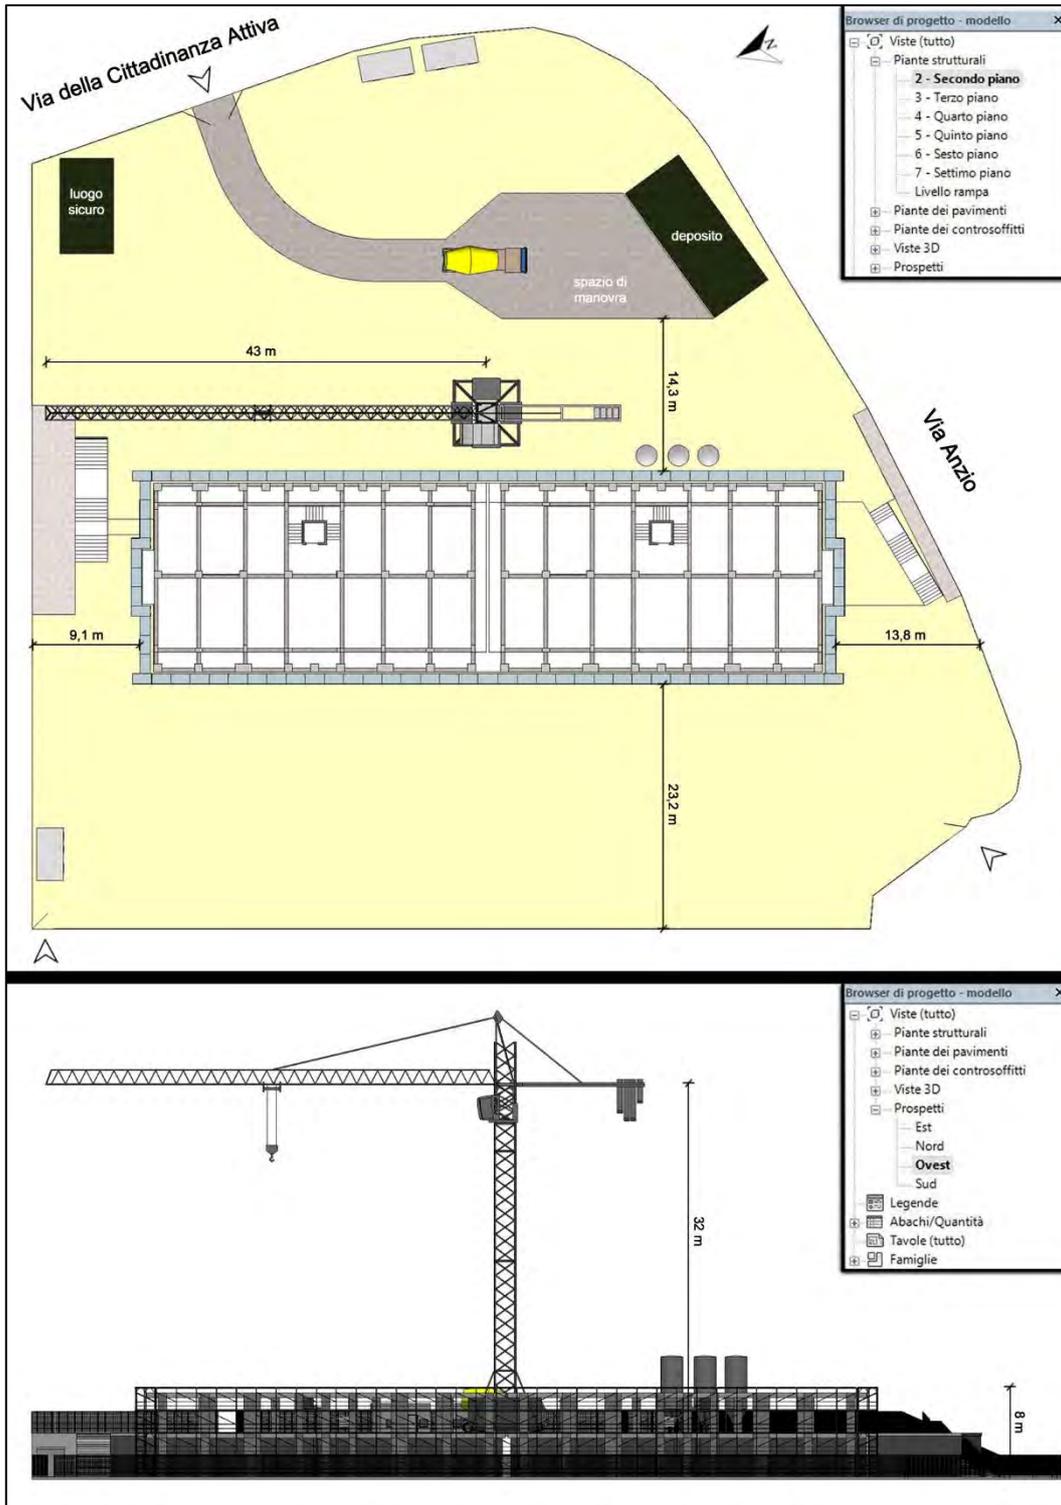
Planimetria e prospetto della fase di allestimento del secondo impalcato
